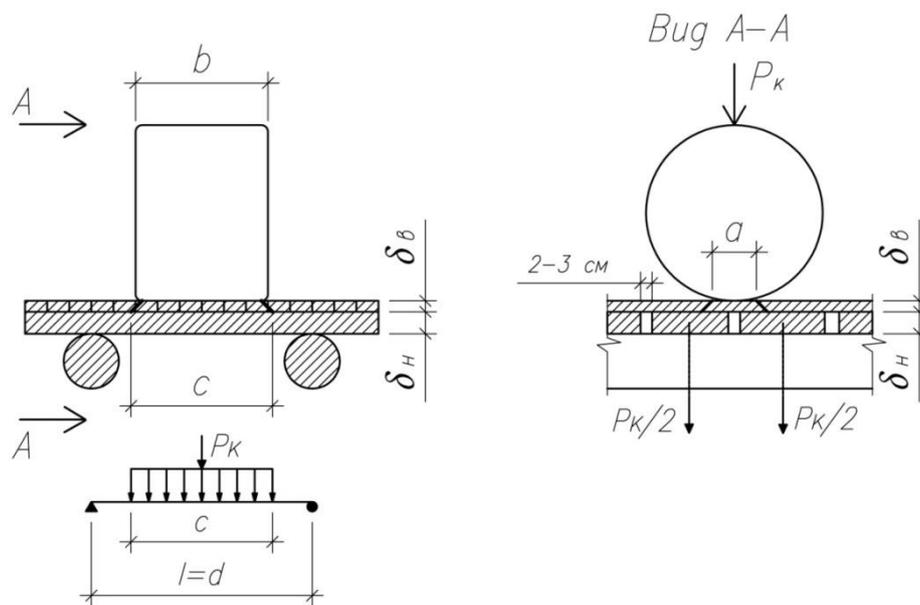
Расчётная схема и схема распределения нагрузки на доски нижнего настила
